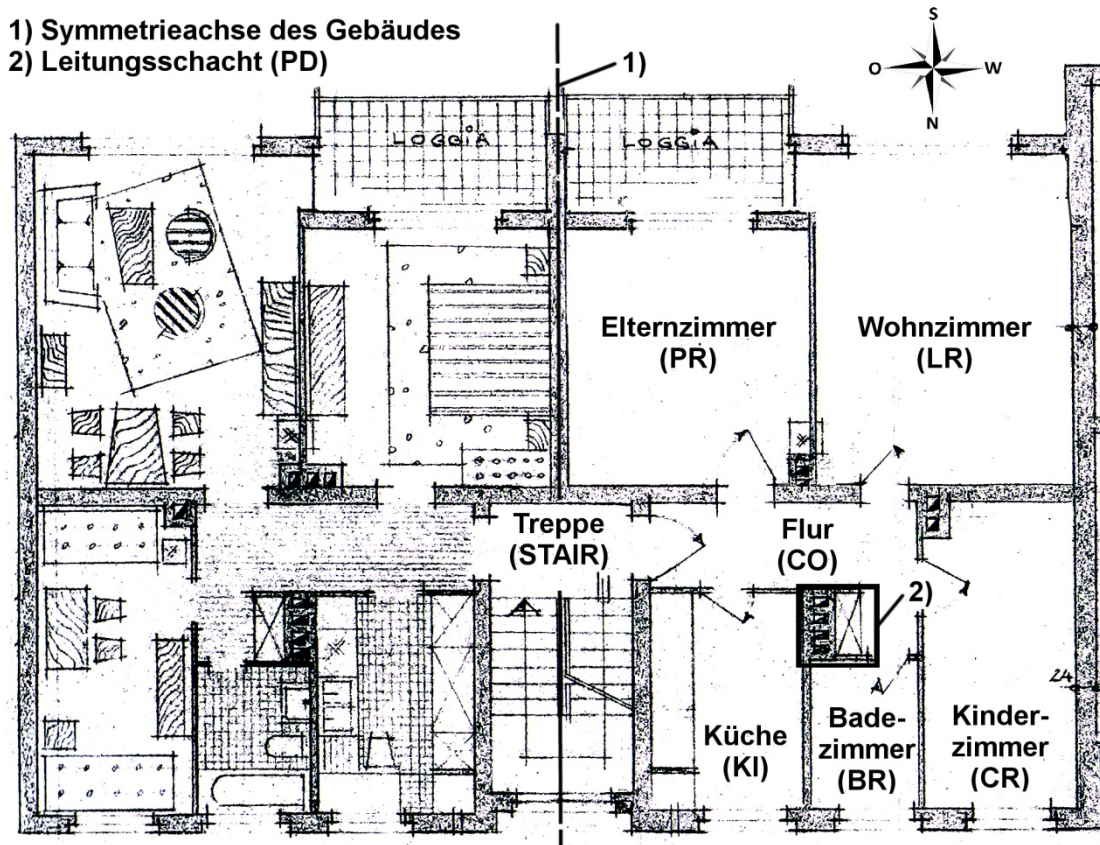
Grundriss einer Etage des Referenzgebäudes
